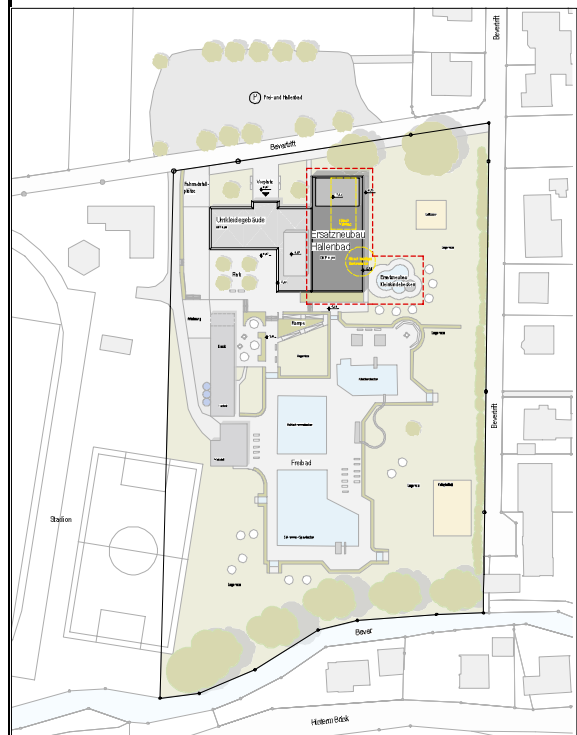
Planung Ersatzneubau Hallenbad Beverungen Kernstadt, pbr Planungsbüro Rohling AG, Stand 28.10.2020. Förderantrag „Wohnviertel im Wandel“ 10/2023
